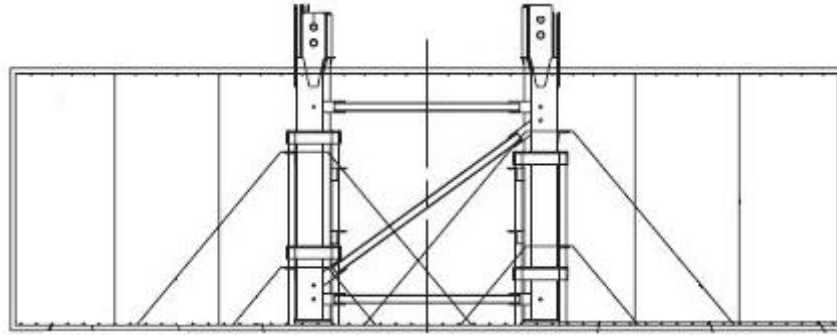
Detalle del tramo empotrado dentro del hormigón.
